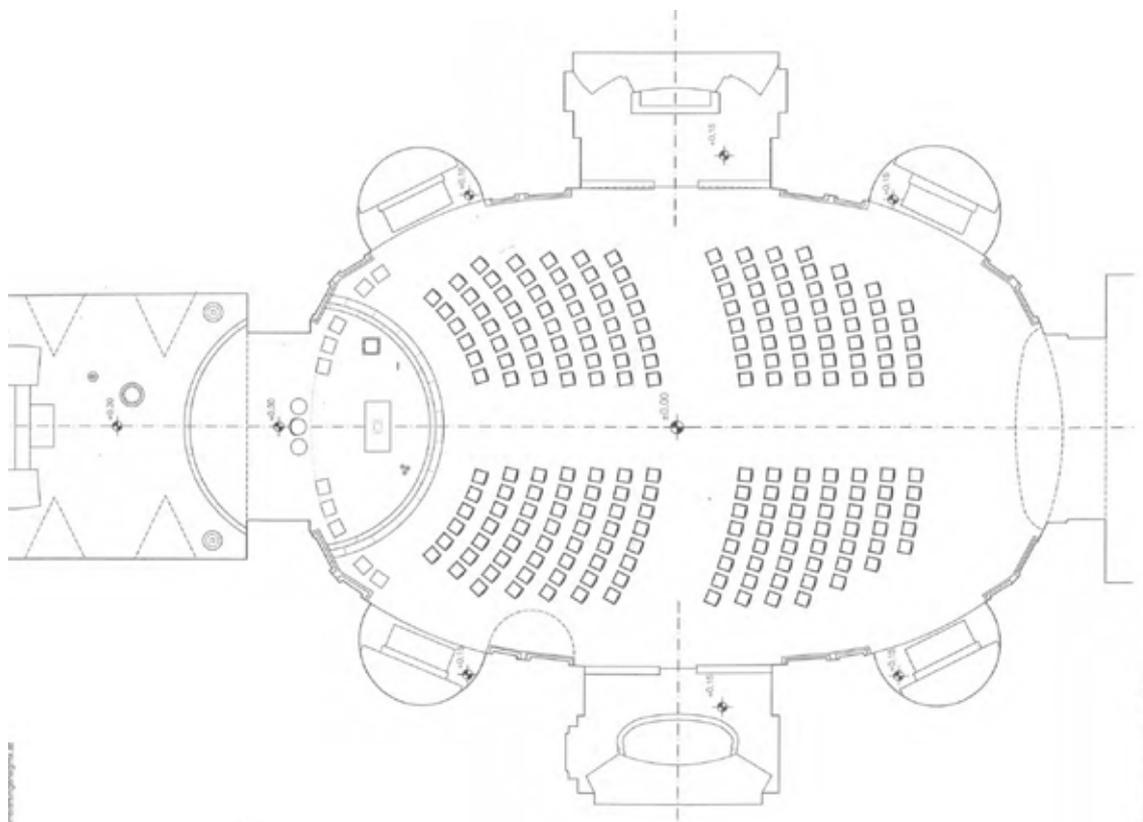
Entwurf zur Neuorganisation der Inneneinrichtung der Pfarrkirche Rossau. Grundriss (genordet) © Architekt Martin Feiersinger ([www.rossau.at/servitenkirche/kircheninnenrenovierung/20170625\\_KIR-Praesentation\\_web.pdf](http://www.rossau.at/servitenkirche/kircheninnenrenovierung/20170625_KIR-Praesentation_web.pdf))
